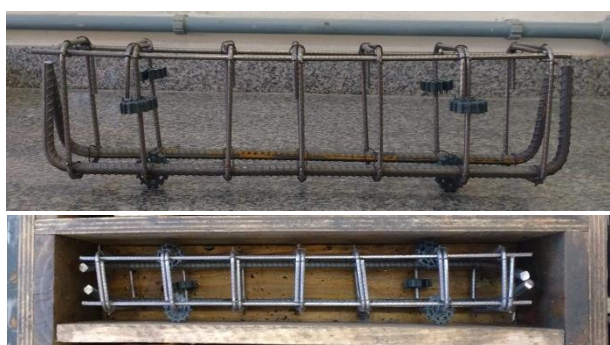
Armadura V02 com estribos convencionais 1 Ø 5,0 mm c/ 7,5 cm.
